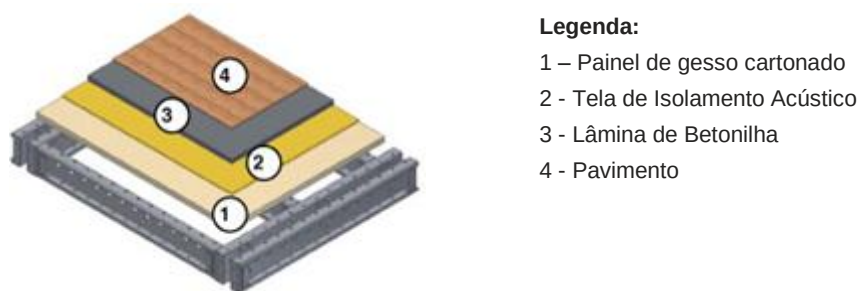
Solução de configuração das lajes com lâmina em betonilha [48]
